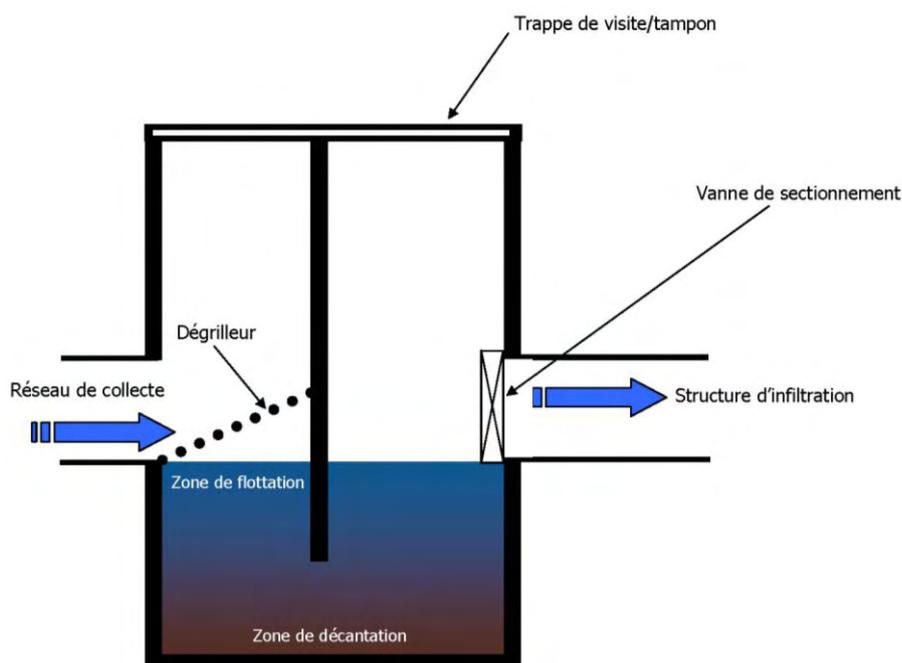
coupe de principe d'une cloison siphonide en amont d'un ouvrage d'infiltration
